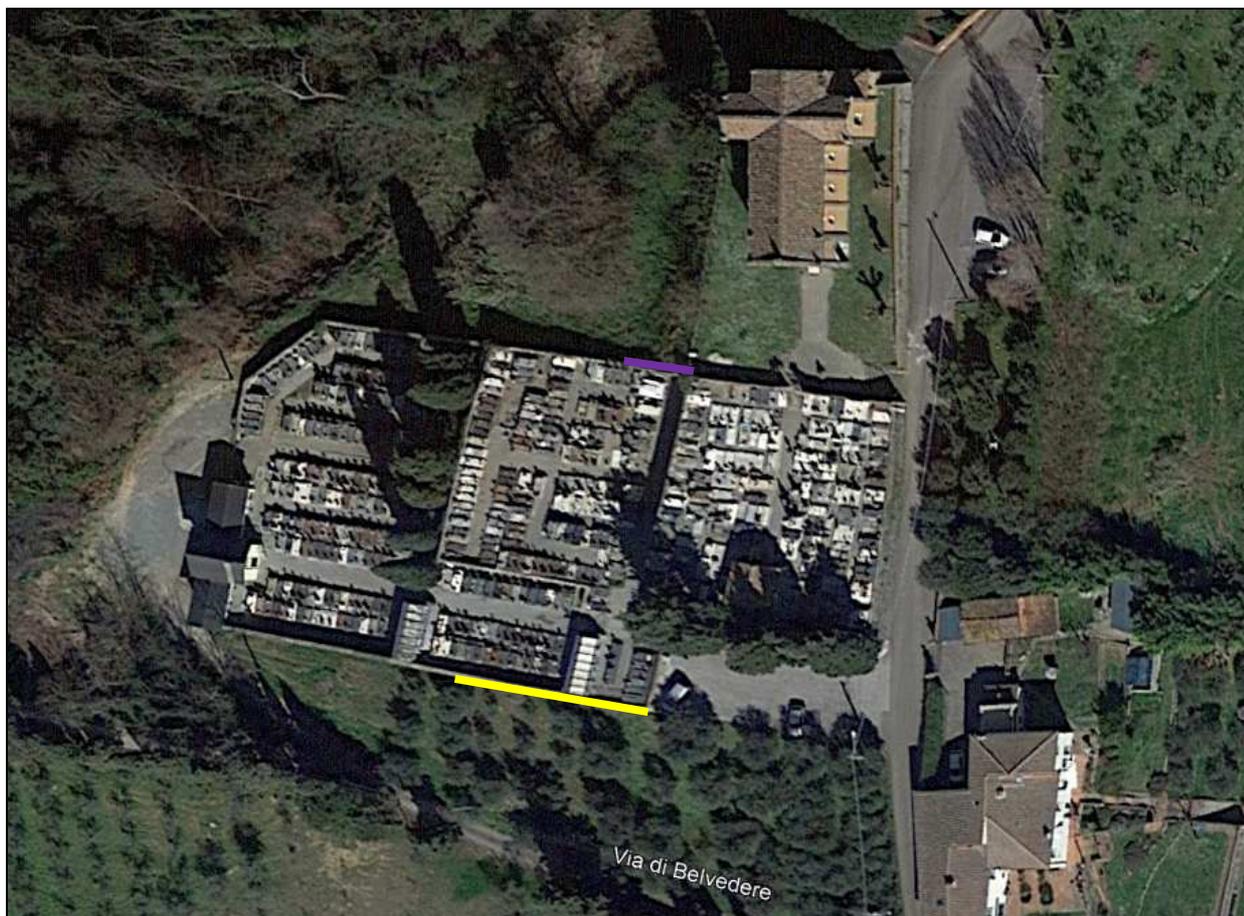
foto area con individuazione dei tratti instabili del muro di confine del cimitero e della zona di ampliamento
